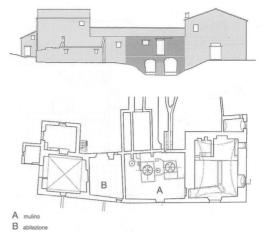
Mulino del Purgatorio, Moscufo (Pe). Pianta e prospetto (disegno dell'autore 2013)
